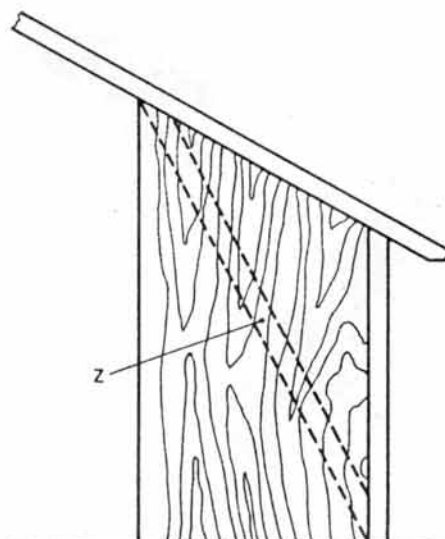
Les poutres obliques et les entrails (Z) faisant saillie dans le foin entreposé doivent être revêtus de cette manière. Si le revêtement va le long des poutres, il se produit des fuites d'air dues au tassement du foin.
